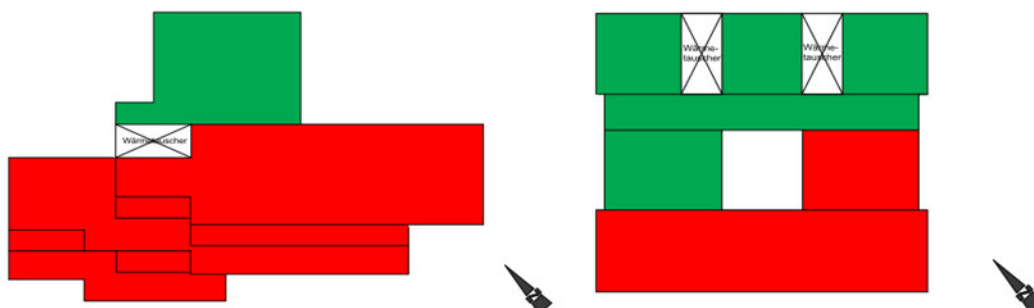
Grundrisse Gebäudeteile 1 und 2, Vernetzung solar günstig orientierter mit ‚rückwärtigen‘ Raumfolgen [Architekten Keß und König]
